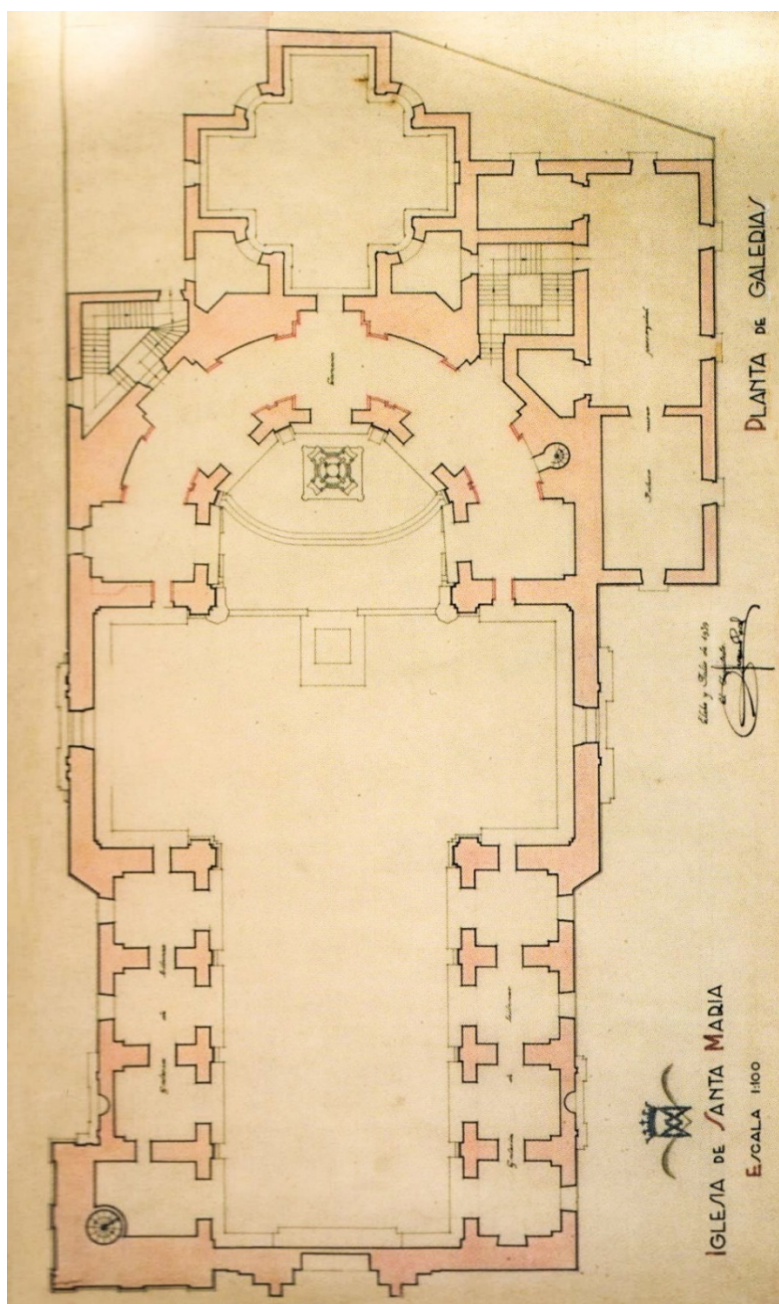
Plano de la planta superior. Proyecto de Restauración de la Iglesia de Santa María de Elche de Antonio Serrano en 1940 (Ajuntament d'Elx, 2010).
